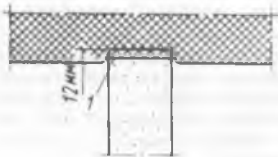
Упругая прокладка, закрепленная по верху несущей перегородки для предотвращения передачи нагрузки от плиты сверху
